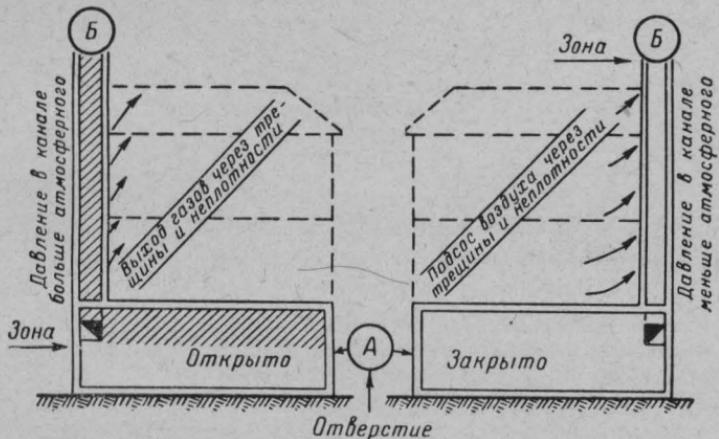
Влияние шахт и вытяжных вентиляционных каналов в горящем помещении на расположение нейтральной зоны
